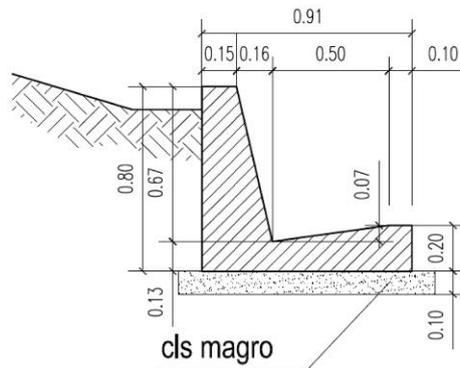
Sezione tipo cunetta triangolare con profilo alto
